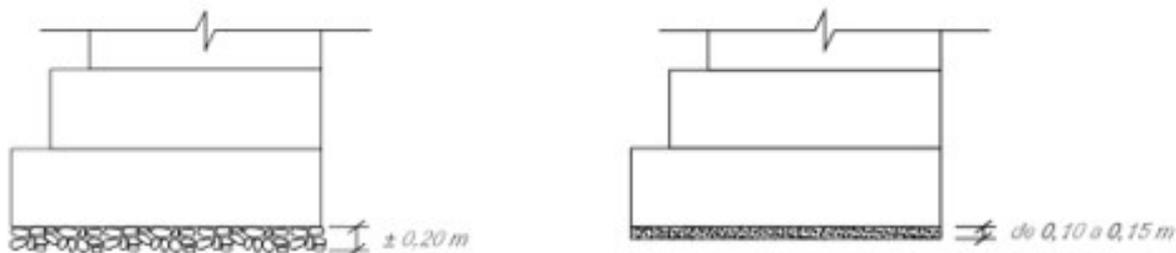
Detalhe da preparação do terreno na cota de apoio da estrutura
